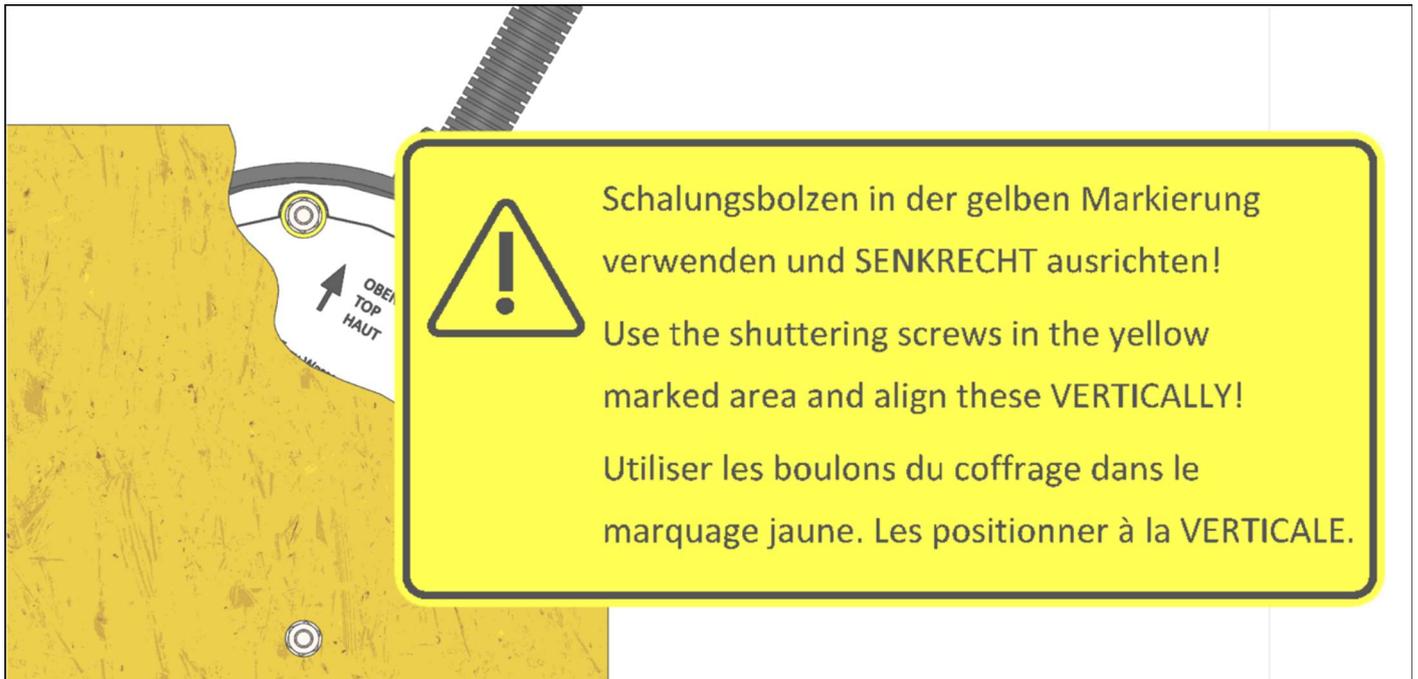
Hinweis Einbausituation Betonbecken mit Folienabdichtung
